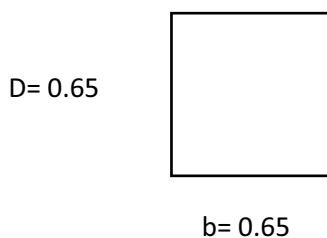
Sección final de columna. Fuente: Elaboración Propia.
